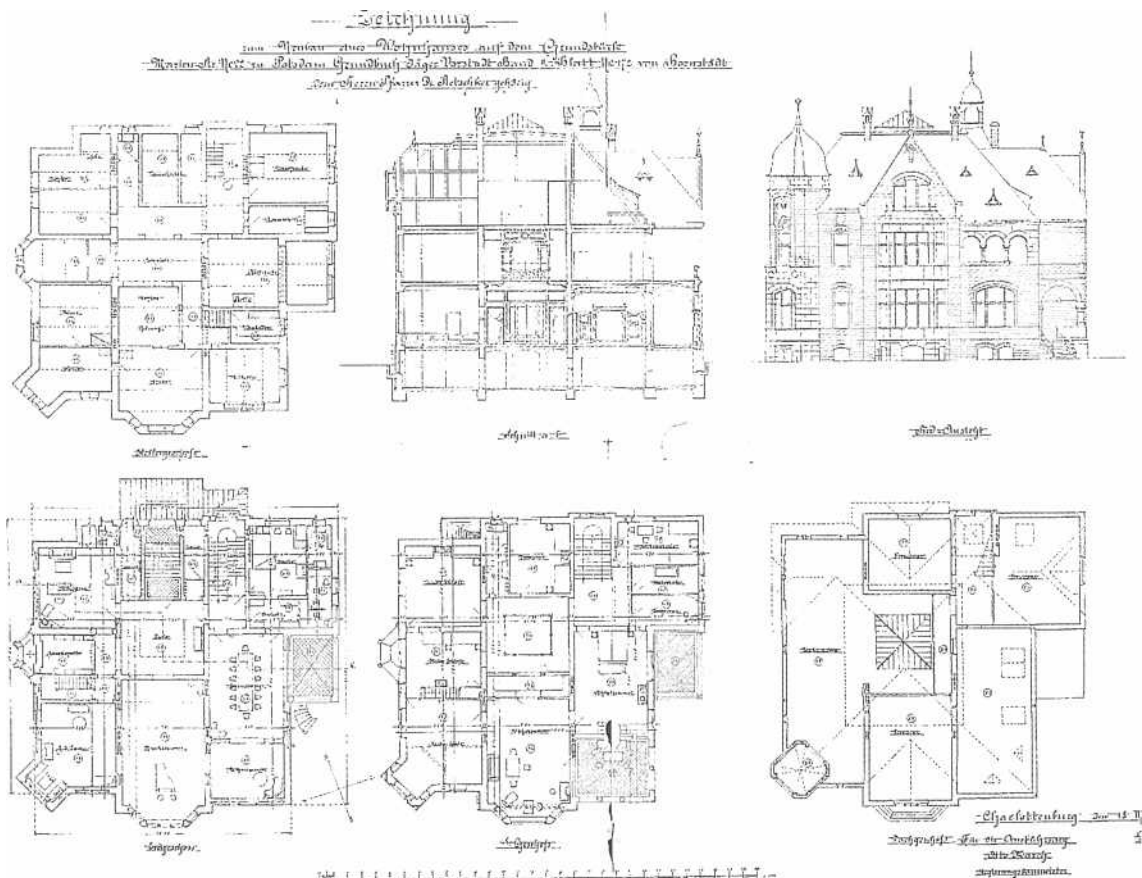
„Zeichnung zum Neubau eines Wohnhauses auf dem Grundstück Marien-Str. Nr. 22 zu Potsdam Grundbuch Jäger Vorstadt Band II, Blatt Nr. 172 von Bornstädt, dem Herrn Pfarrer Dr. Pietschker gehörig“. Grundrisse Keller, Erdgeschoss, Obergeschoss, Dach; Schnitt a b; Südansicht, ausgeführt von Otto March, Regierungsbaumeister, 18. 3. 1890, M1: 100, 102,5 x 65,7 cm (Blattgröße), Druck auf Papier, Grundrisse und Schnitt aquarelliert, Grundrisse mit Möblierung; Sammlung Schöning.
